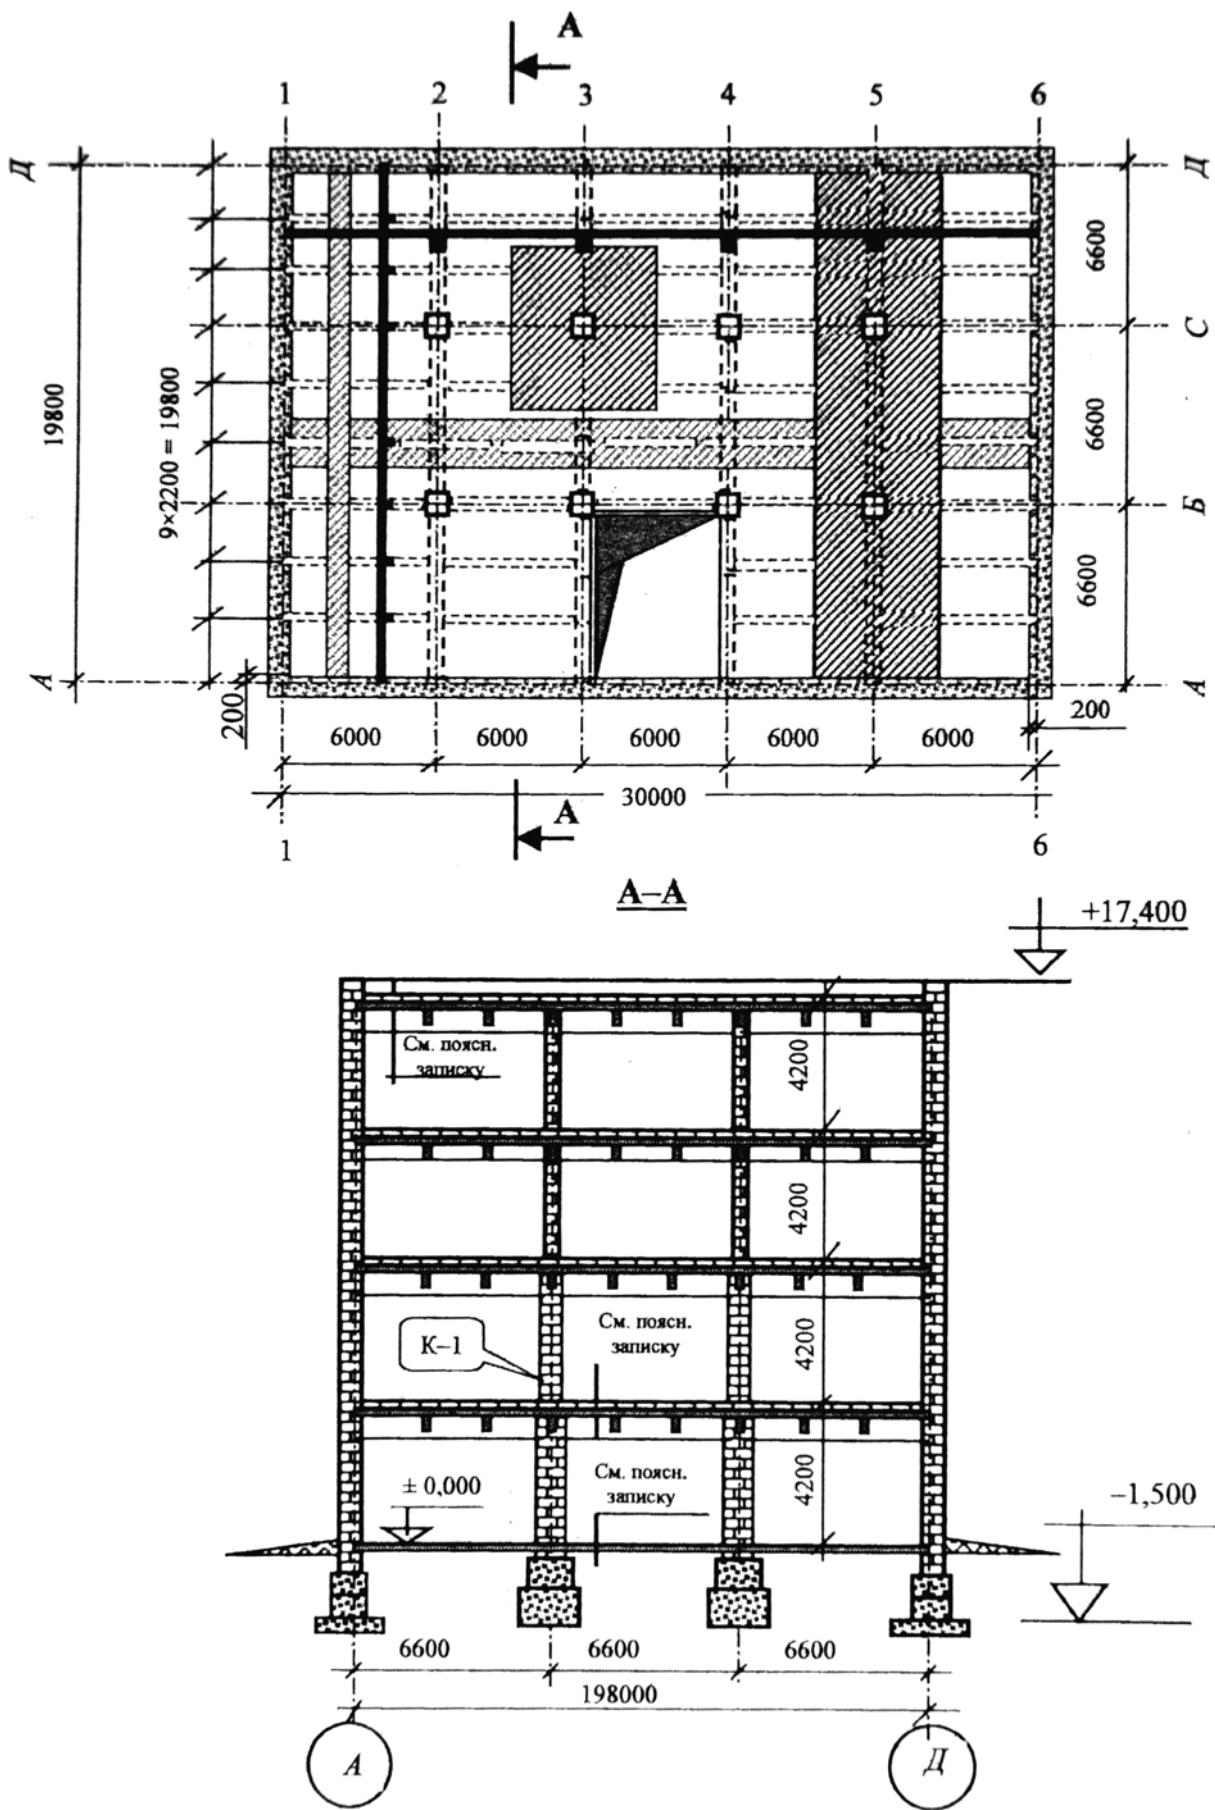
Компонка монолитного междуэтажного перекрытия
